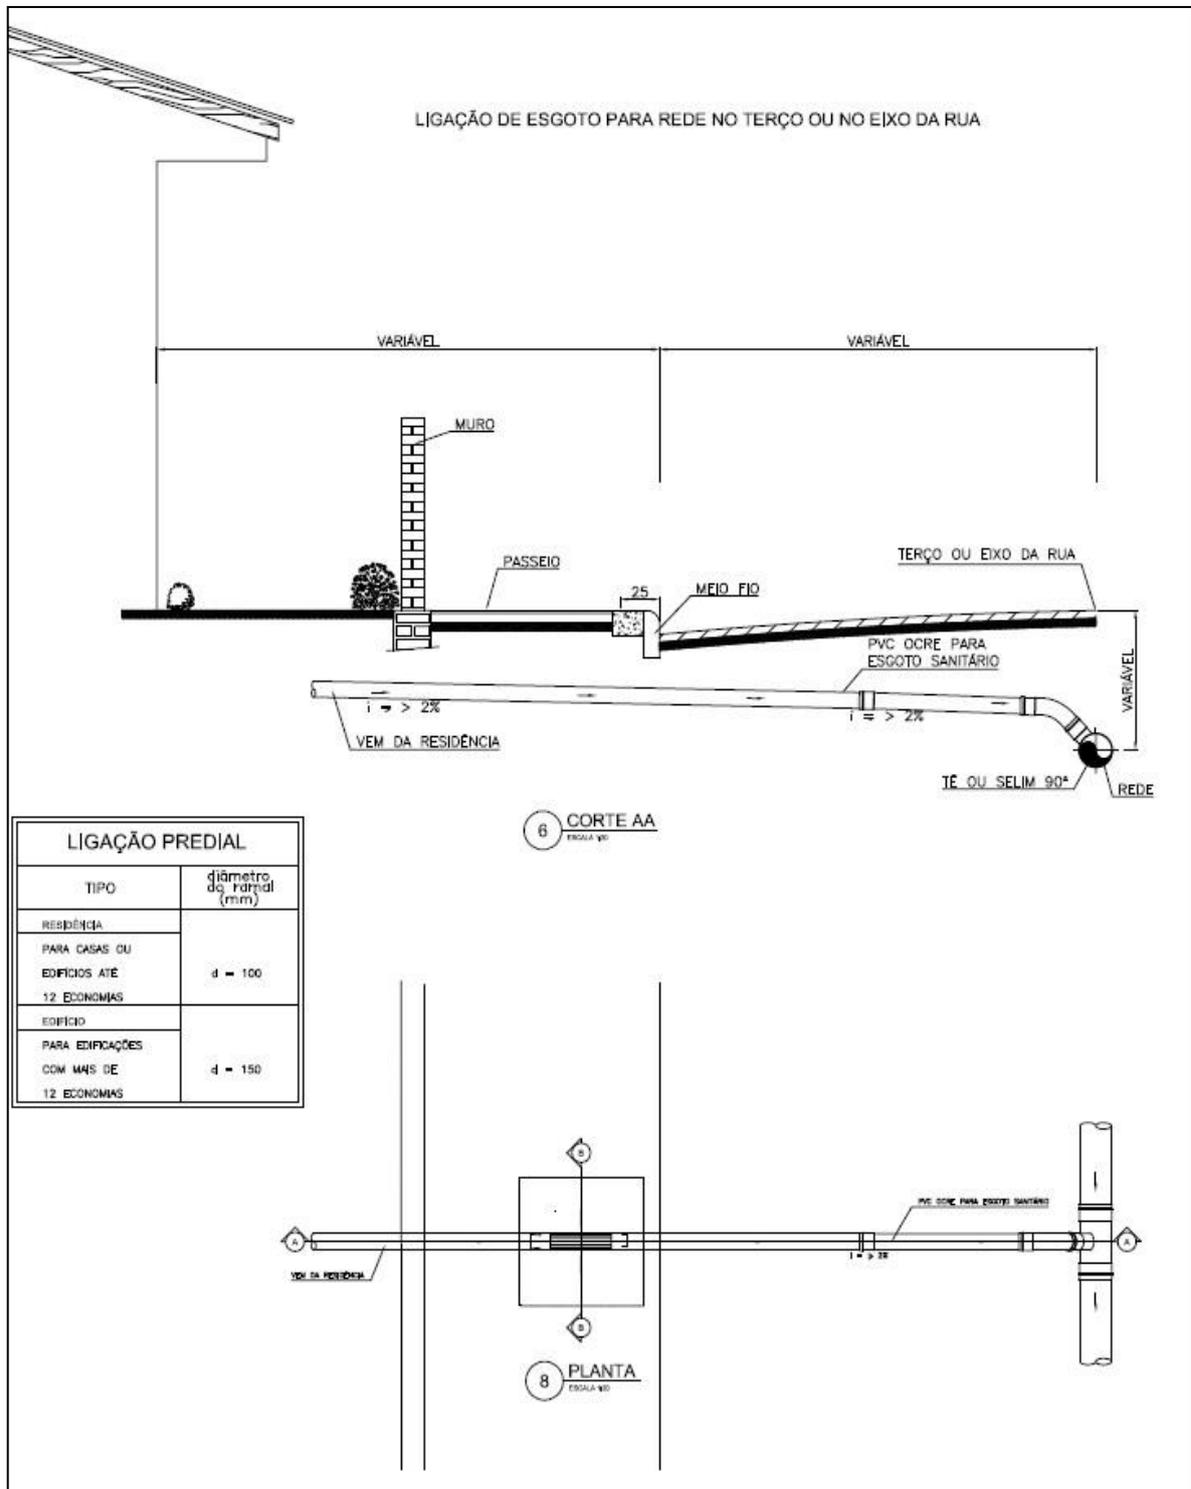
Detalhe da ligação de esgoto no terço ou eixo
